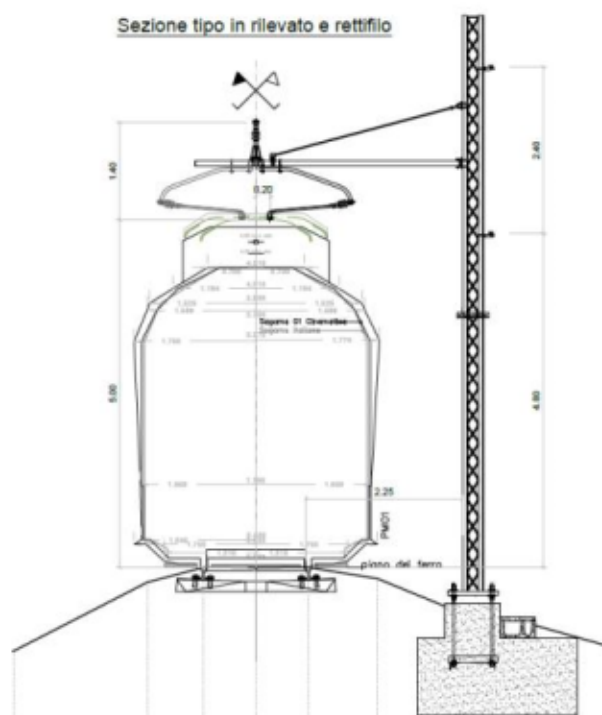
SEZIONE TIPO IN RILEVATO
